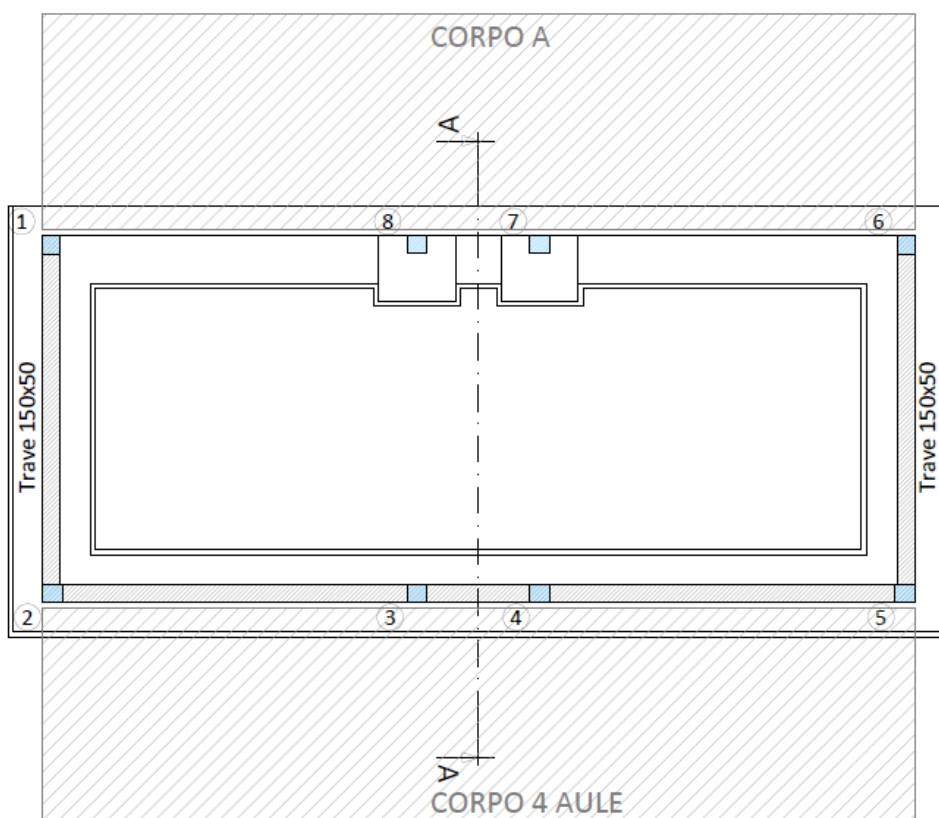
Blocco Q-Planimetria Struttura Fondazione Esistente.
